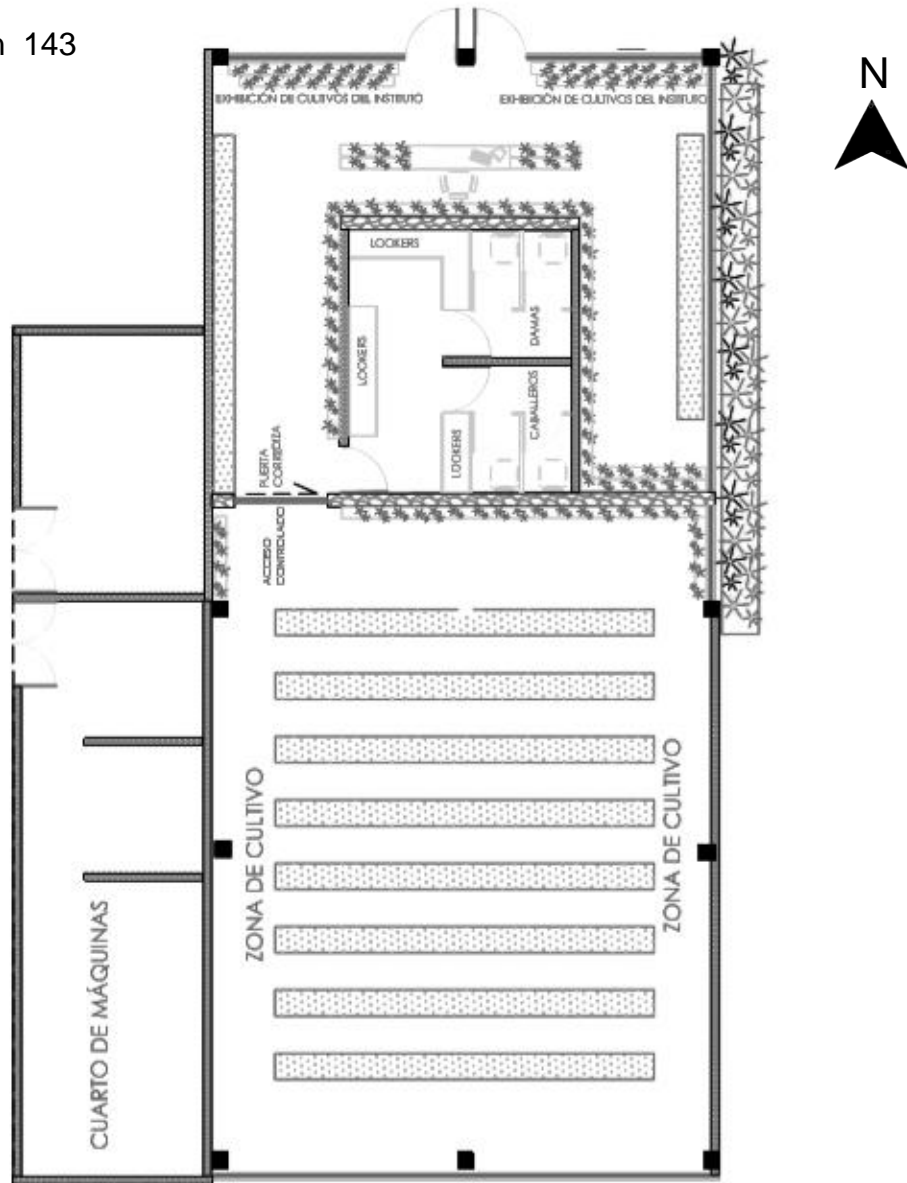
Planta arquitectónica de Invernadero, Centro multidisciplinario Ex hacienda Cusi.
